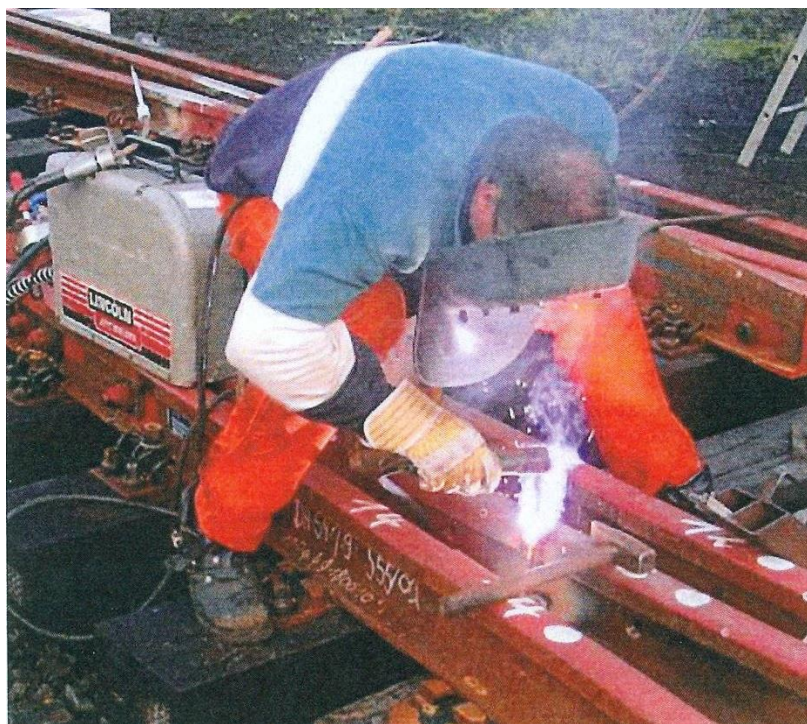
Электродуговая сварка рельсов¹
